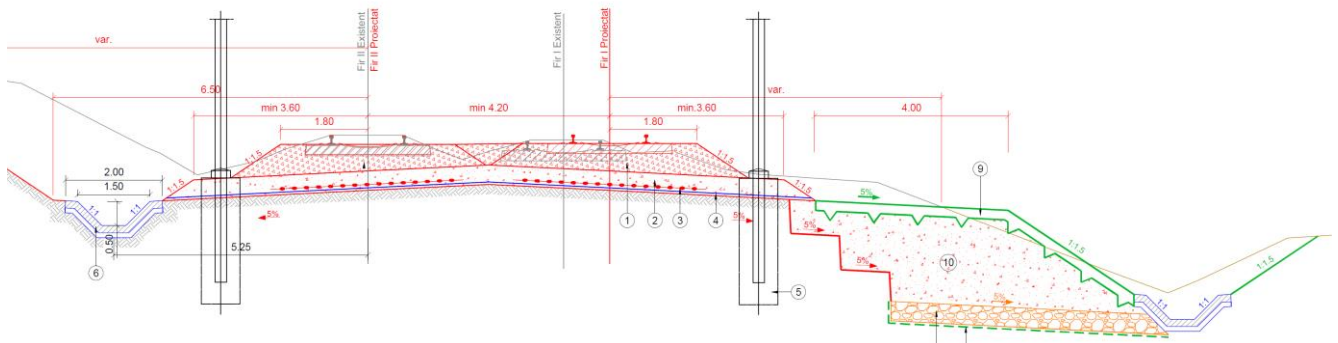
Profil transversal mixt cu contrabancheta cu blocaj de anrocamente
